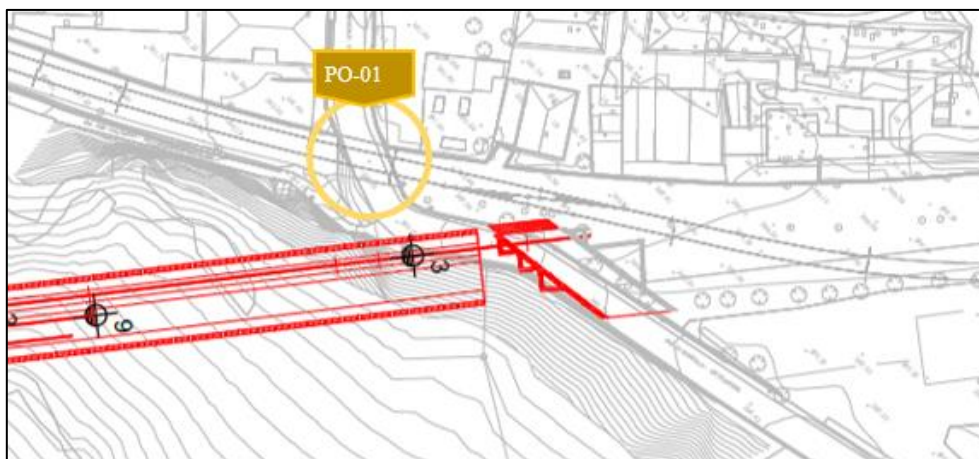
Stralcio planimetrico ponticello via Pie' di Virgolo
